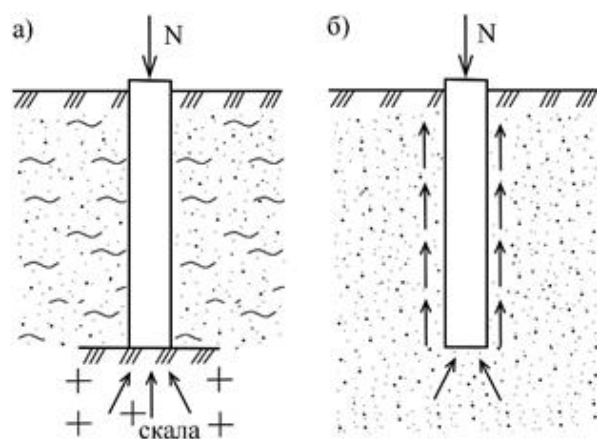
Схема передачи нагрузки сваями на грунты и основания:
